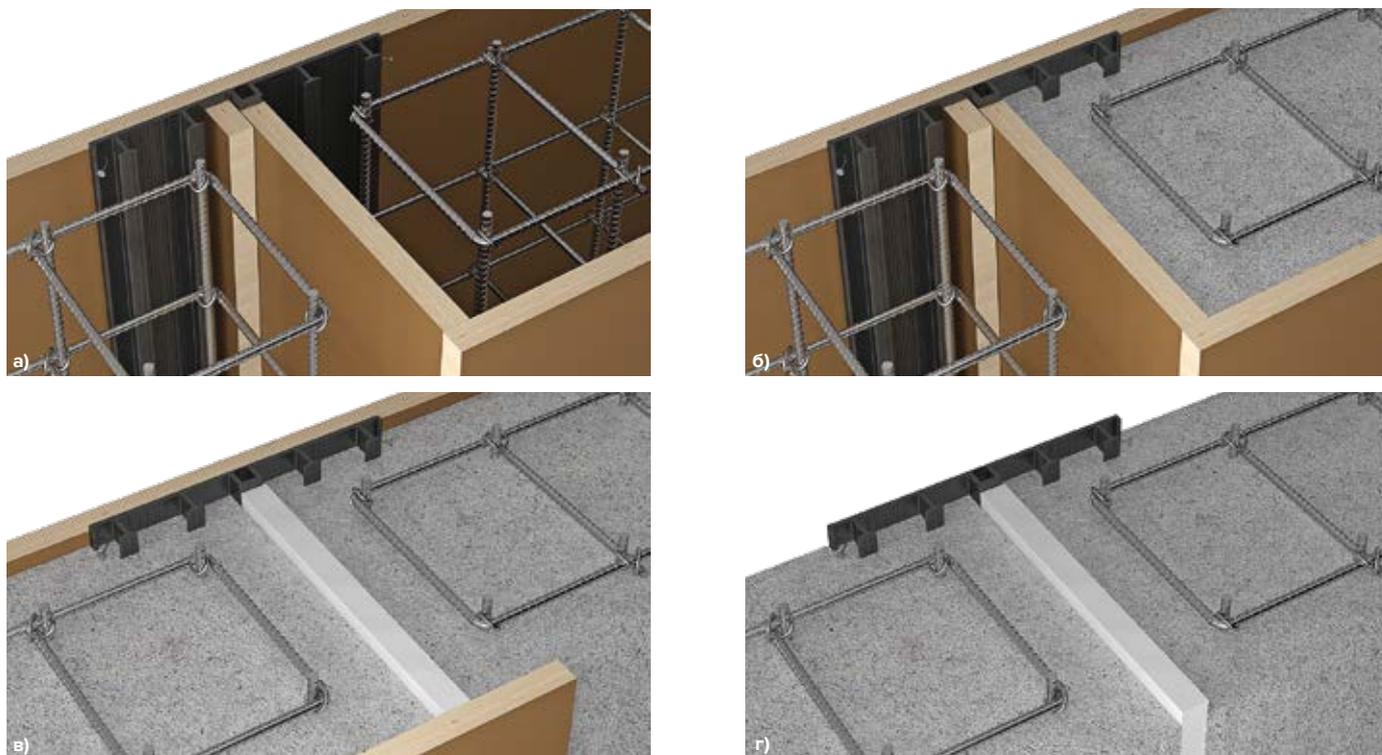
Этапы работ по установке гидрошпонок серии ТН Фундамент ДШН
